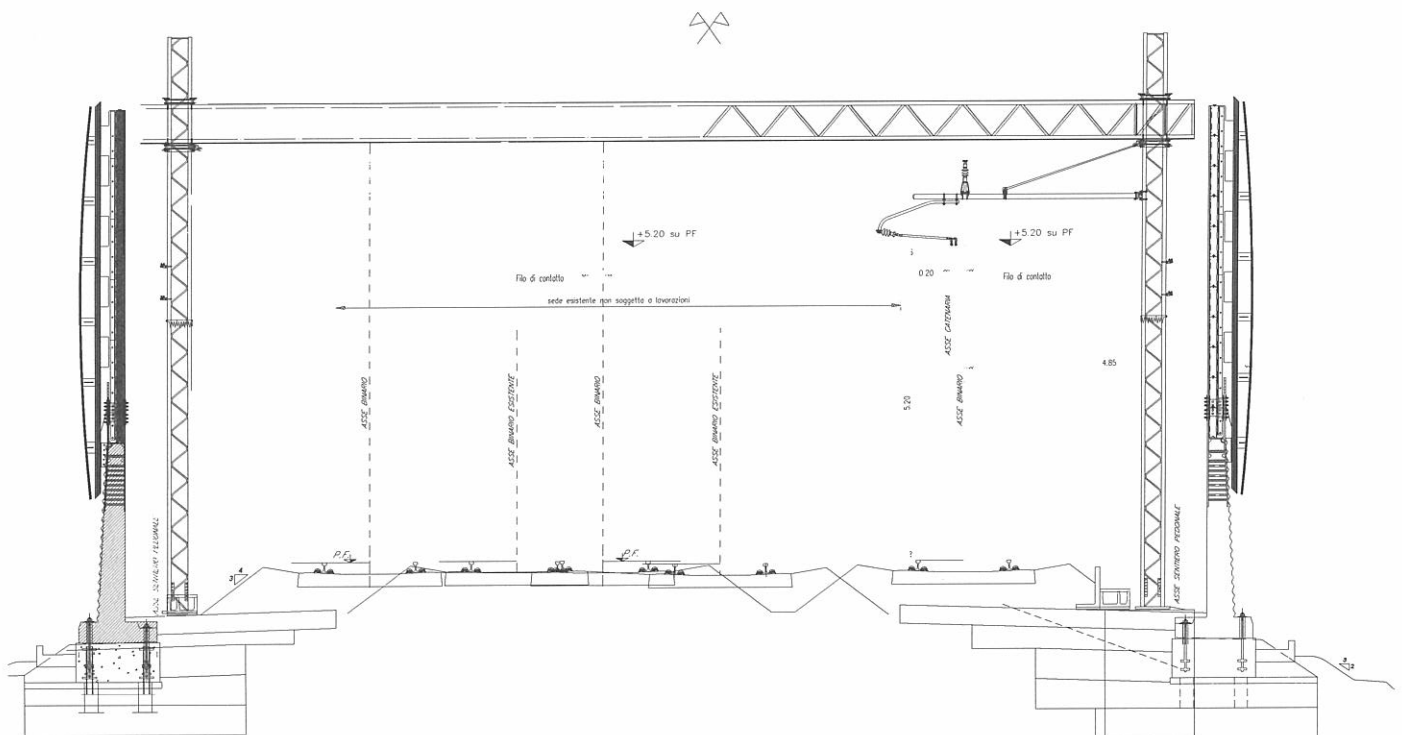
Sezione indicativa sospensioni TE sotto trave MEC e barriera fonoassorbente verticale
